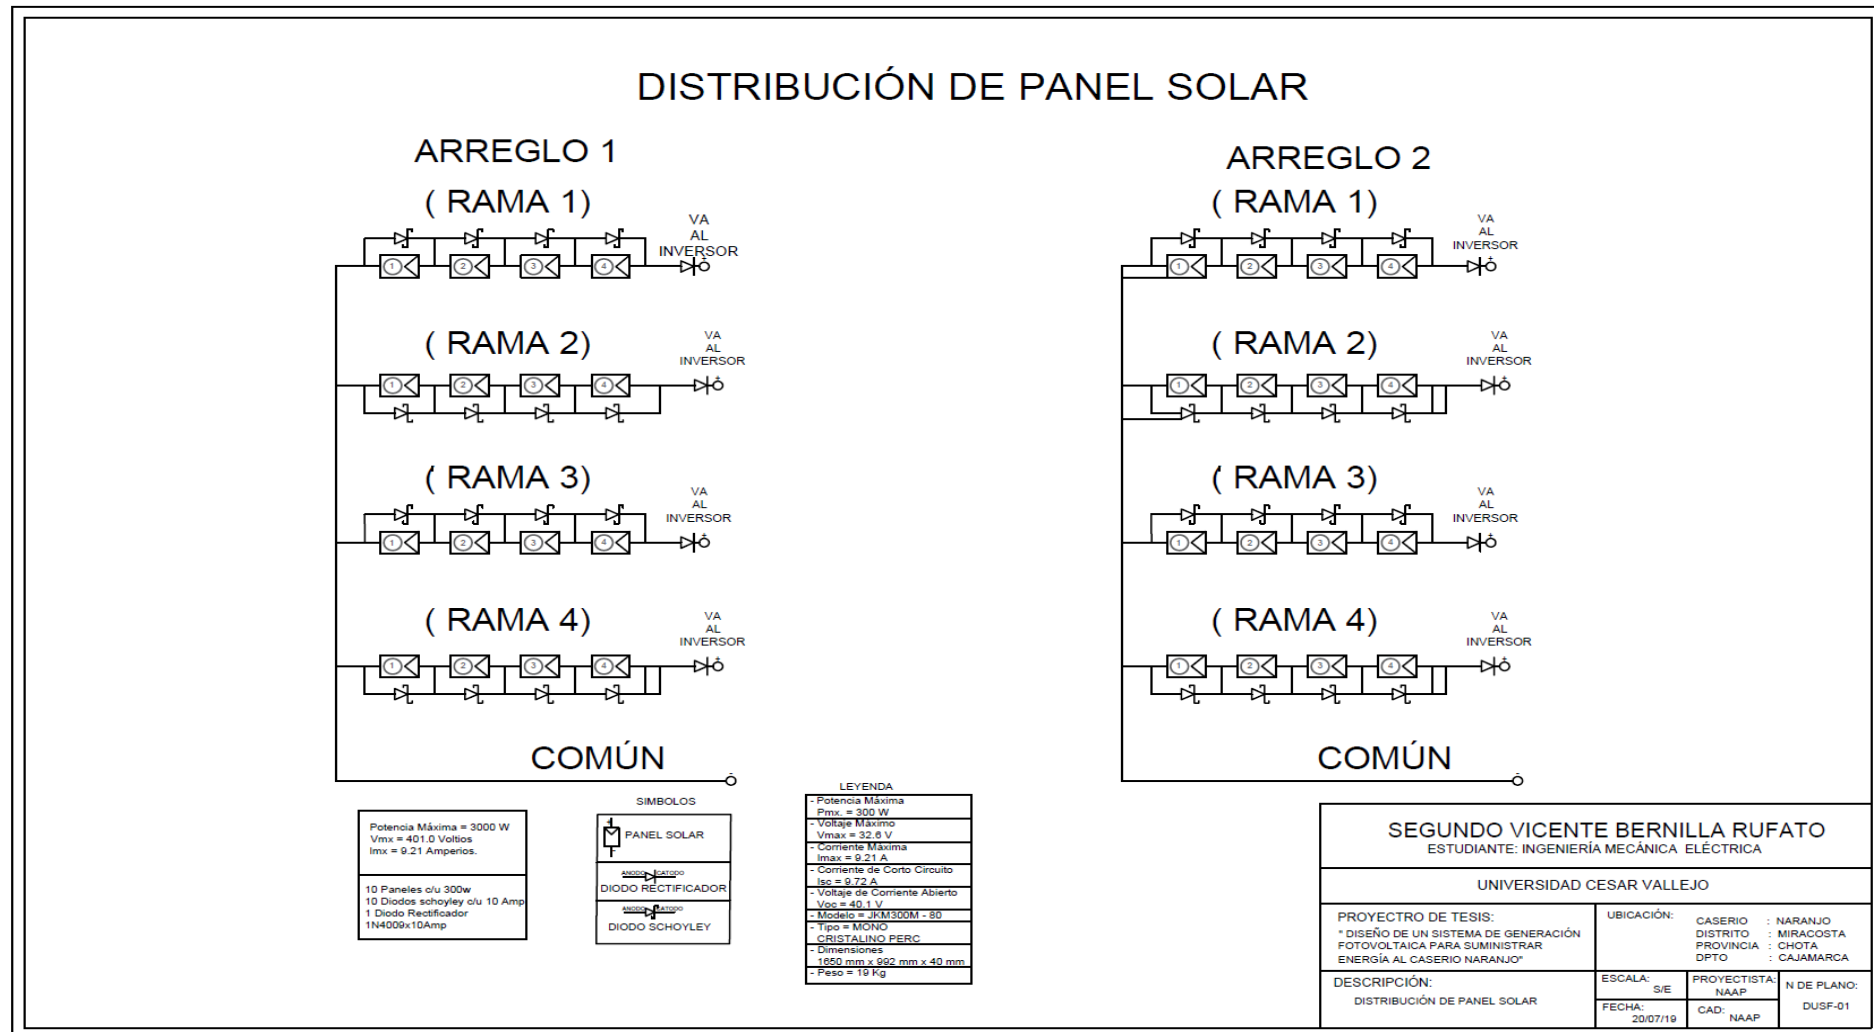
Plano de distribución de paneles solares en la planta fotovoltaica.
